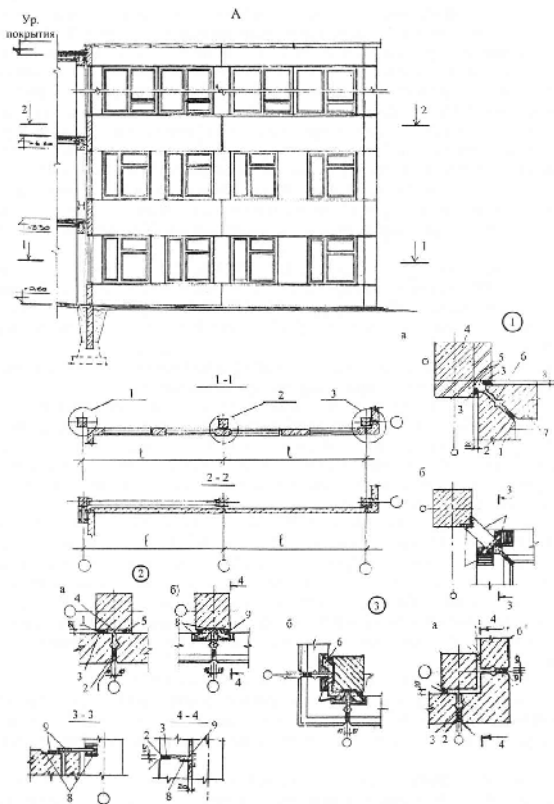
Фрагмент фасада каркасного здания серии 1.020-1: А — схема разрезки наружной стены на панели; а — герметизация вертикальных стыков; б — крепление верха панели к колонне; 1 — защитный слой; 2 — эластичная мастика; 3 — упругий шнур (гермит); 4 — колонна; 5 — кирпичная кладка; 6 — цементный раствор; 7 — наружная стеновая панель; 8 — стальные закладные детали; 9 — стальные соединительные элементы
